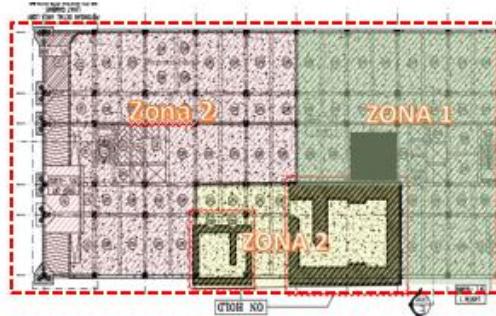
2 Lokasi RSUD dr. M. Soewandhie
